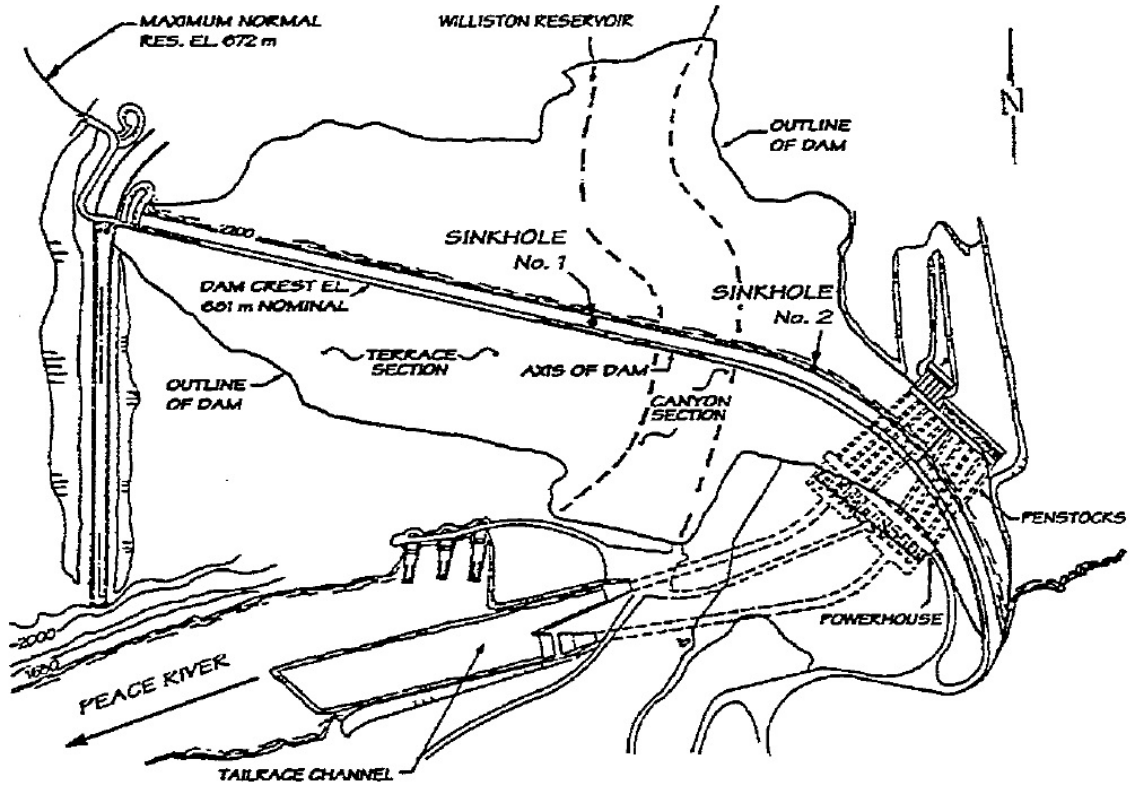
Bennett Damm: Grundriss [44]
